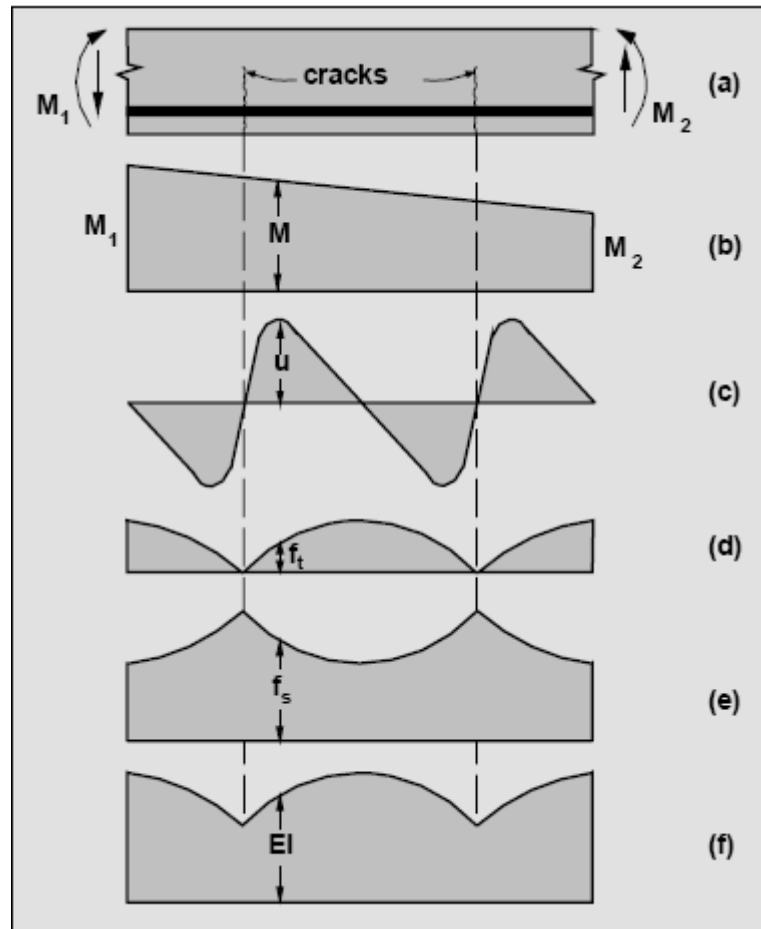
Effet de la fissuration des poutres en béton armé
